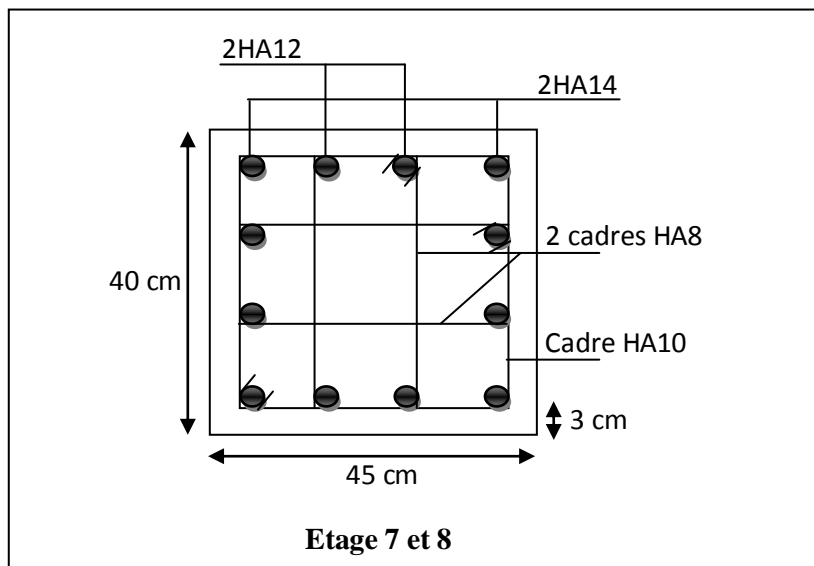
Schéma de ferrailage des poteaux d'étages 7 et 8
